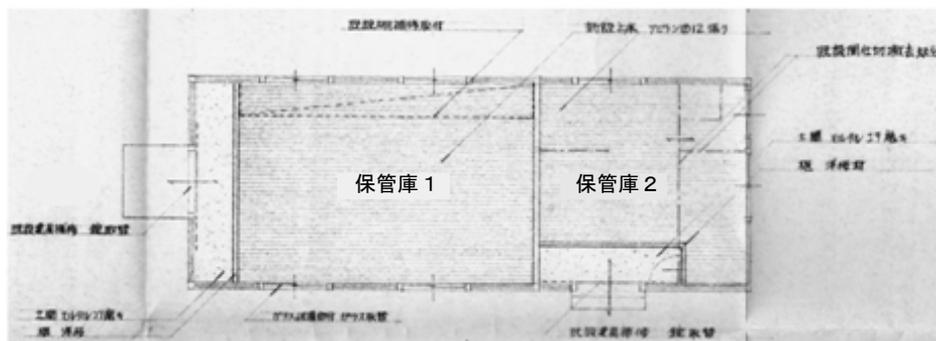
昭和61年（1986）改修時平面図 S=1:200
